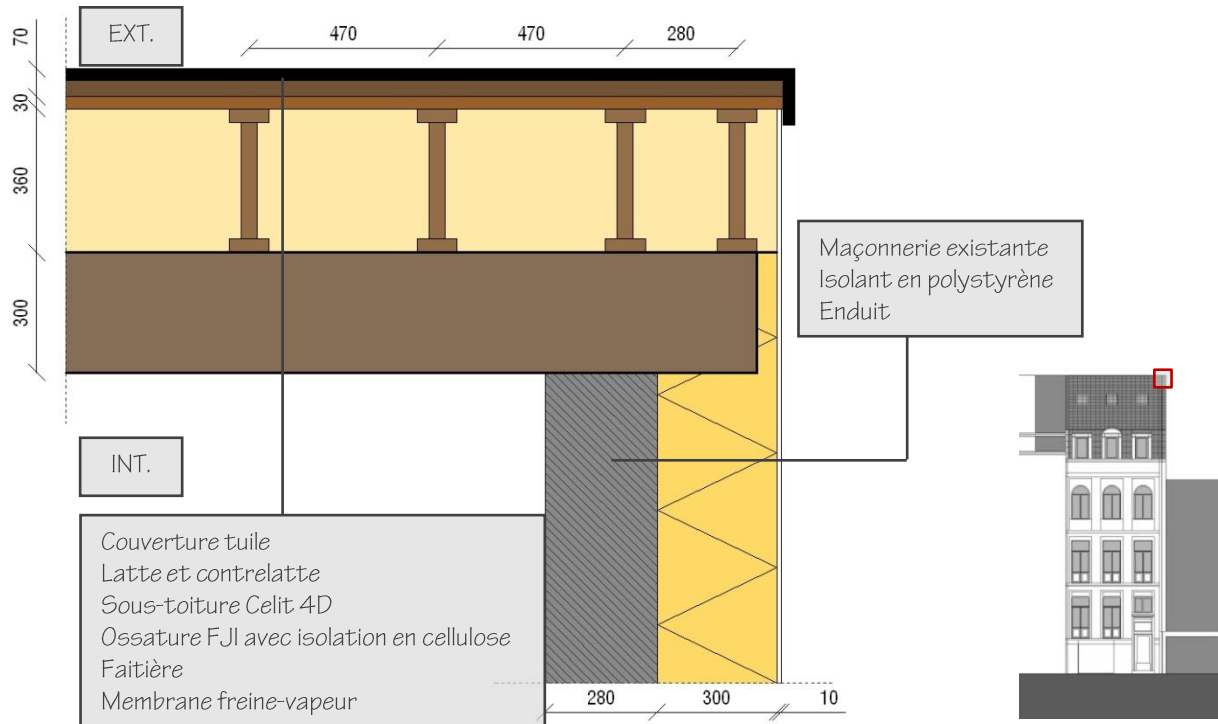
Détail de l'isolation de la toiture et de la façade latérale, mesures en [mm]
